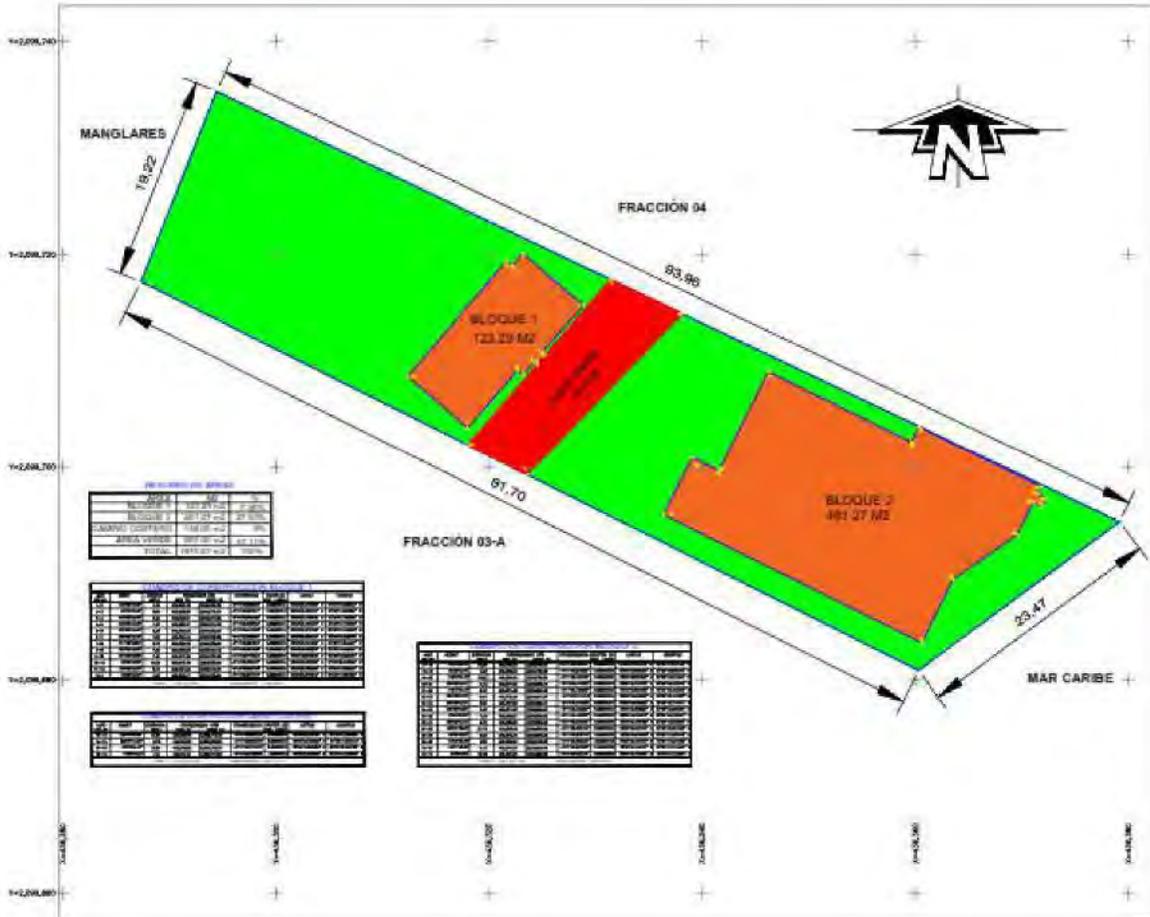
Plano de elementos y bloques de construcción en el contexto del predio.
